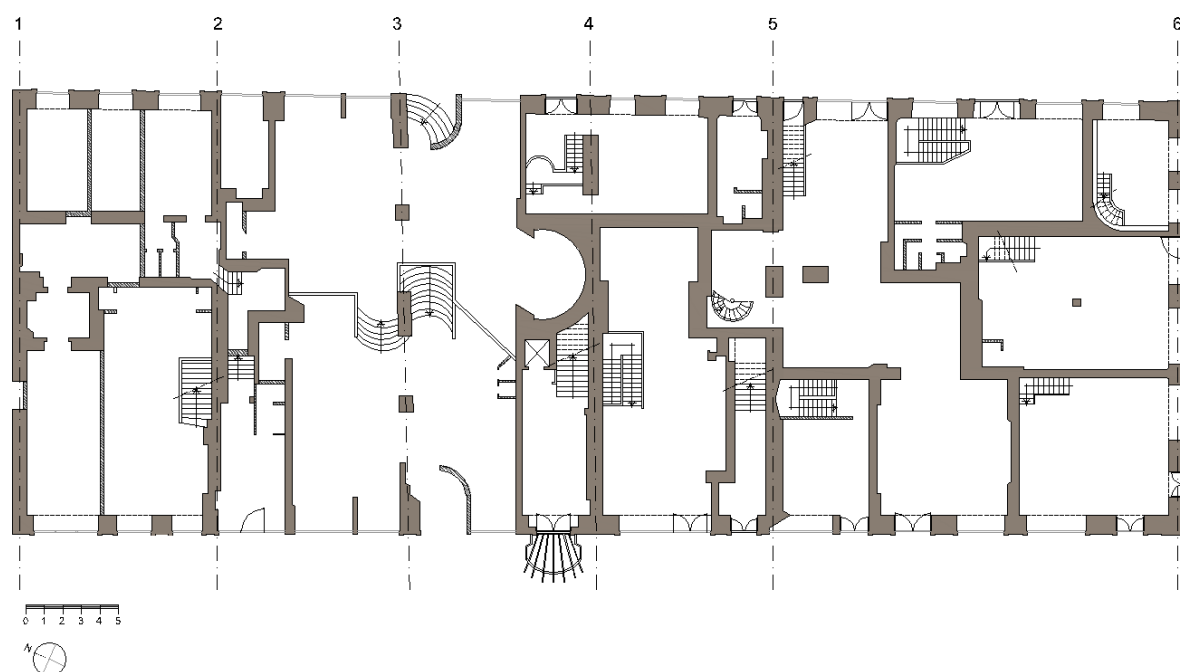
Planta do Piso Térreo – (Levantamento do Existente)
